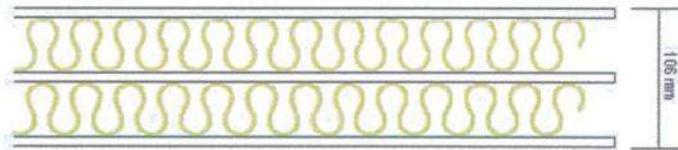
Detalle esquemático de la muestra ensayada.
